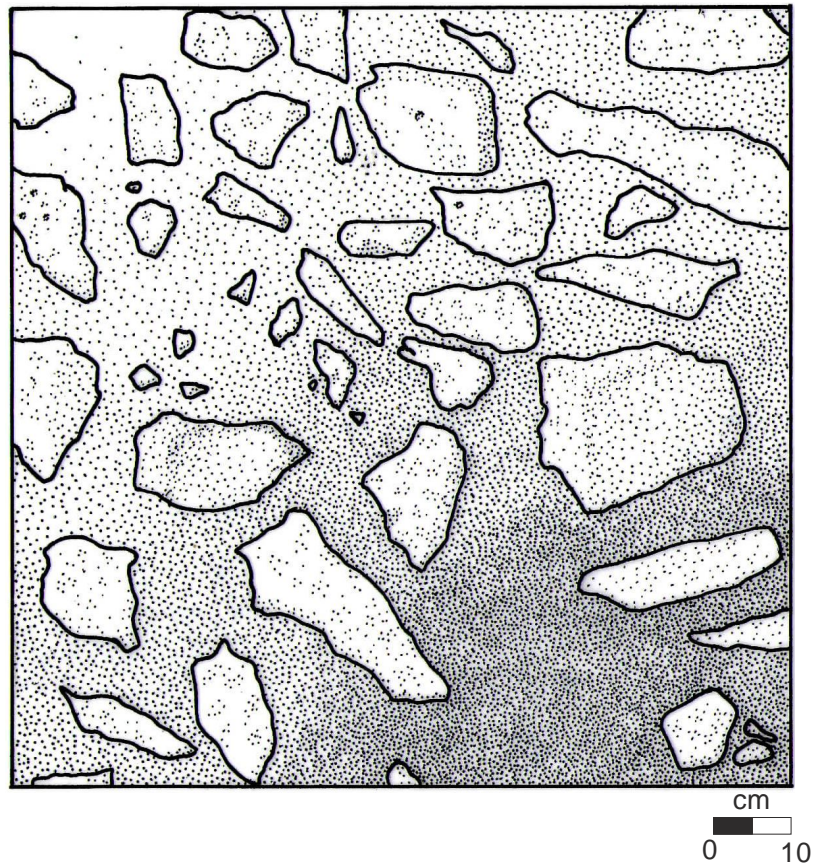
Desenho do aparelho construtivo da via de Relvas.
